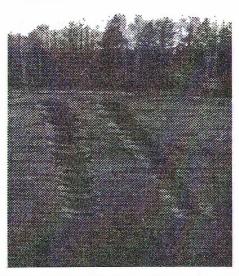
Уложенные на грунтовое основание звенья колесопроводов из боковин автопокрышек
